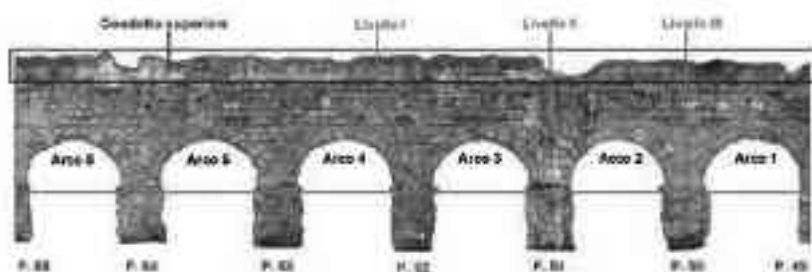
Porzione del prospetto Sud-Ovest interessata dall'Attività Ispettiva
